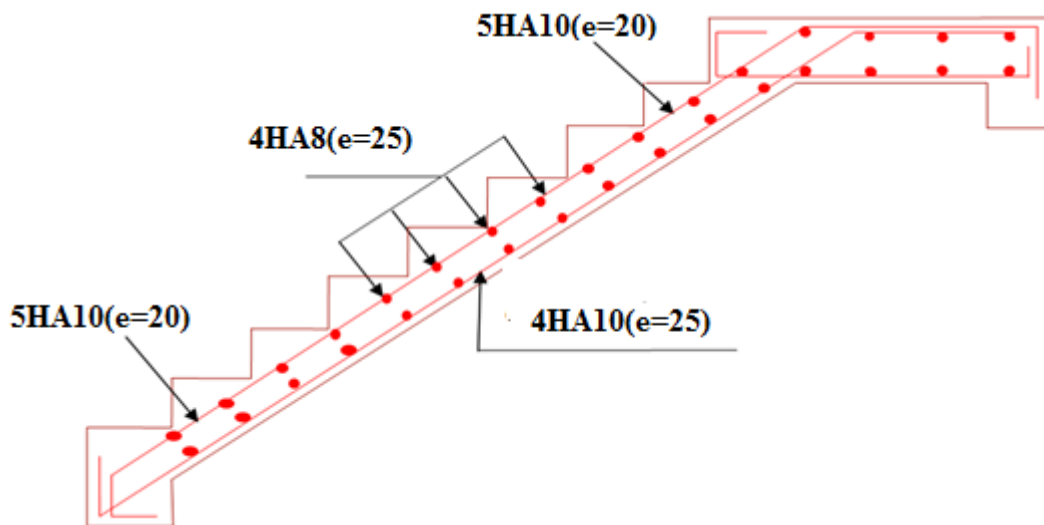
Schéma de ferrailage de l'escalier type 1
